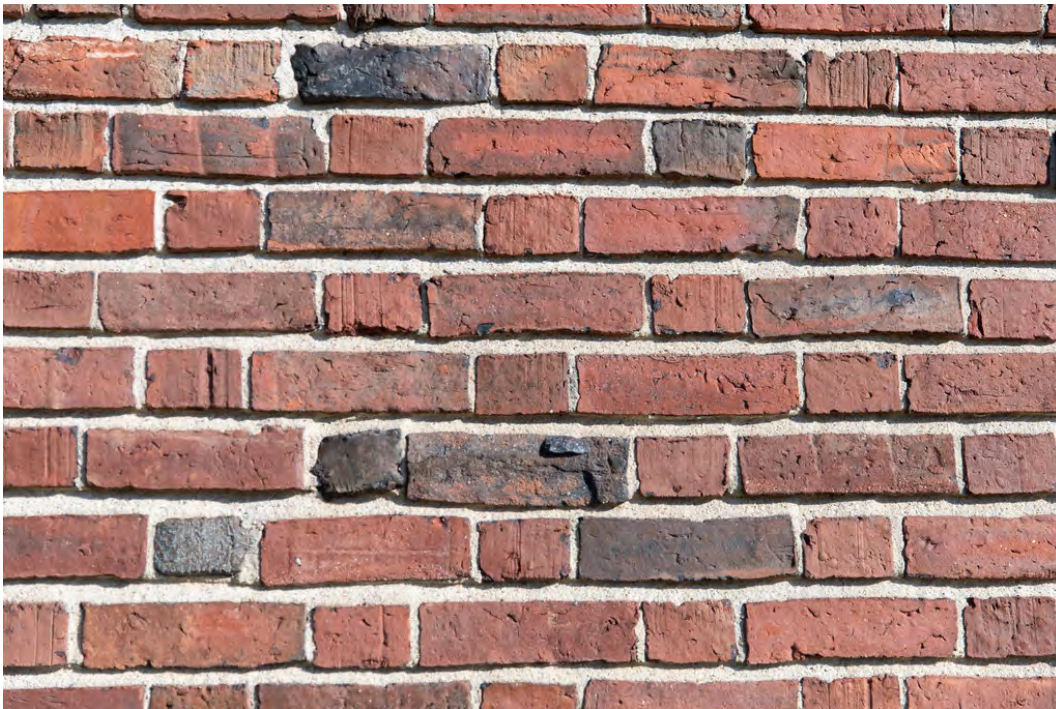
Detalhe dos tijolos da fachada da *Baker House
